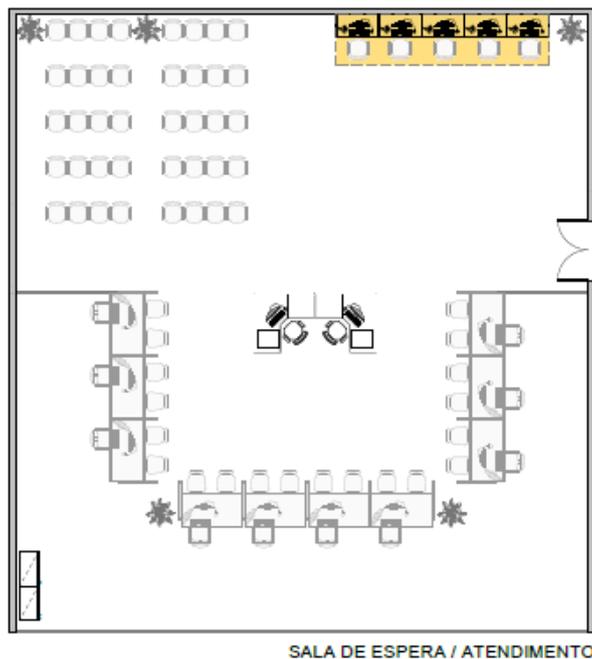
Exemplo de configuração de Autoatendimento Orientado (AAO).
